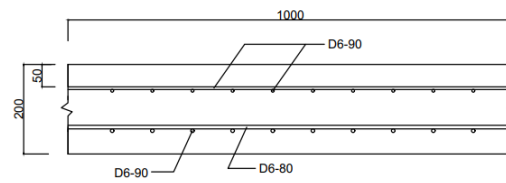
Tampak Samping Pile Cap pada struktur Dermaga
